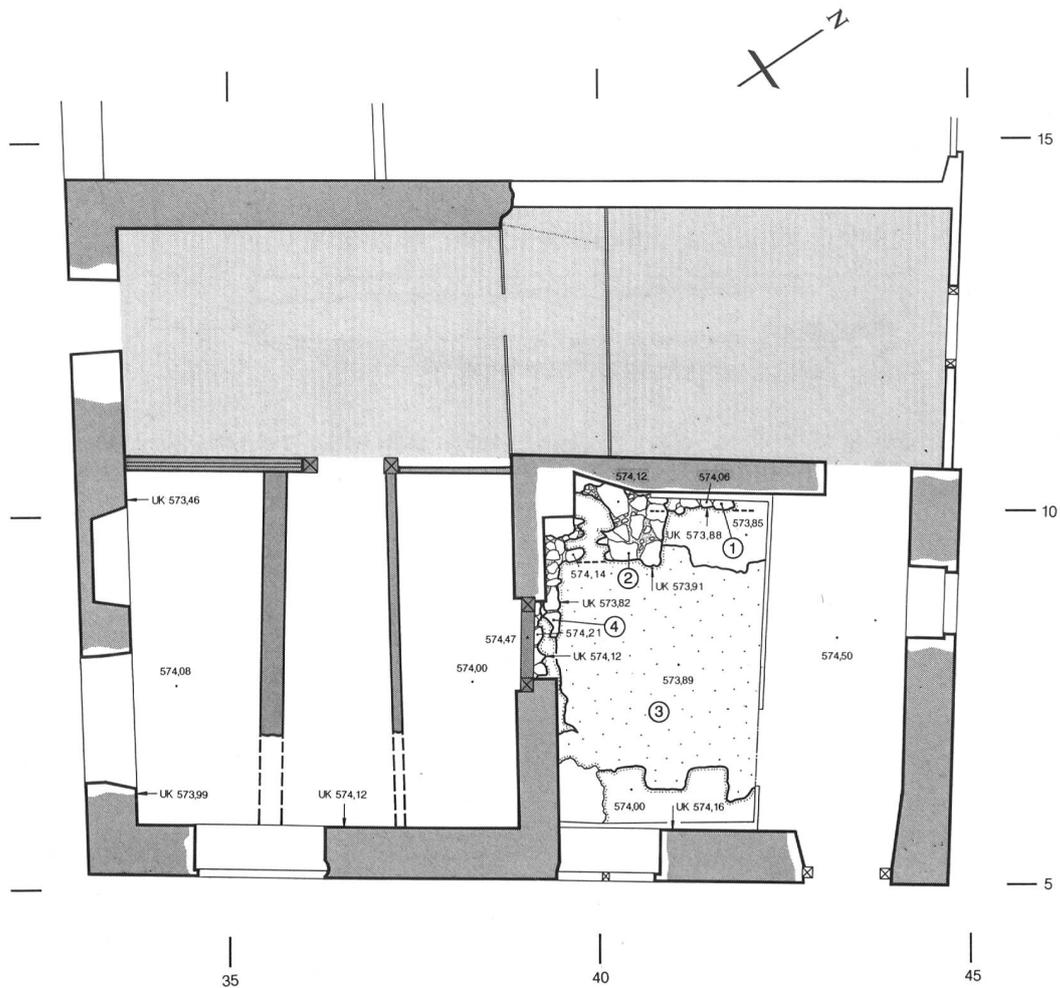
Steffisburg, Industrieweg 10. Grundriss mit älteren Grabungsbefunden M. 1:100. Dunkler Raster: Kernbau von 1528. 1 Unterlegsteine zu Holzbaustruktur eines Vorgängers, 2 Fundation des ersten gewerblichen Ofens, stösst an (2), 3 Lehmestrich im Vorgängerbau, 4 Unterlegsteine zu Schwelle des Vorgängerbaus.
